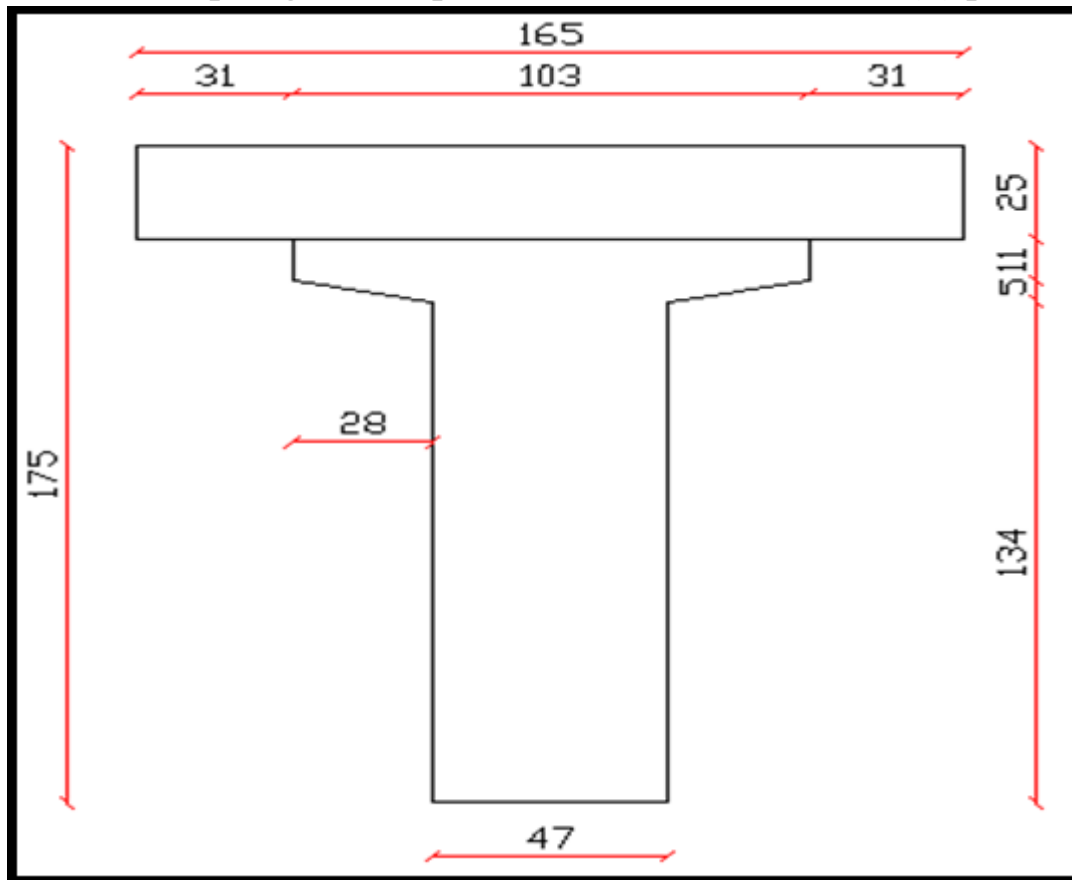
Dimensions de la poutre de la poutre en travée +hourdis
